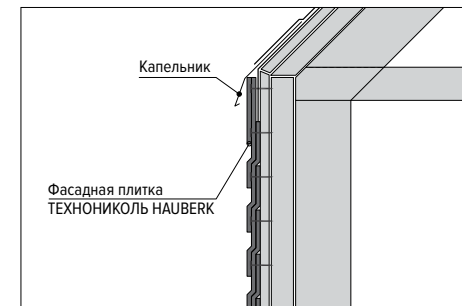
Монтаж верхнего ряда в домах без карнизного свеса
